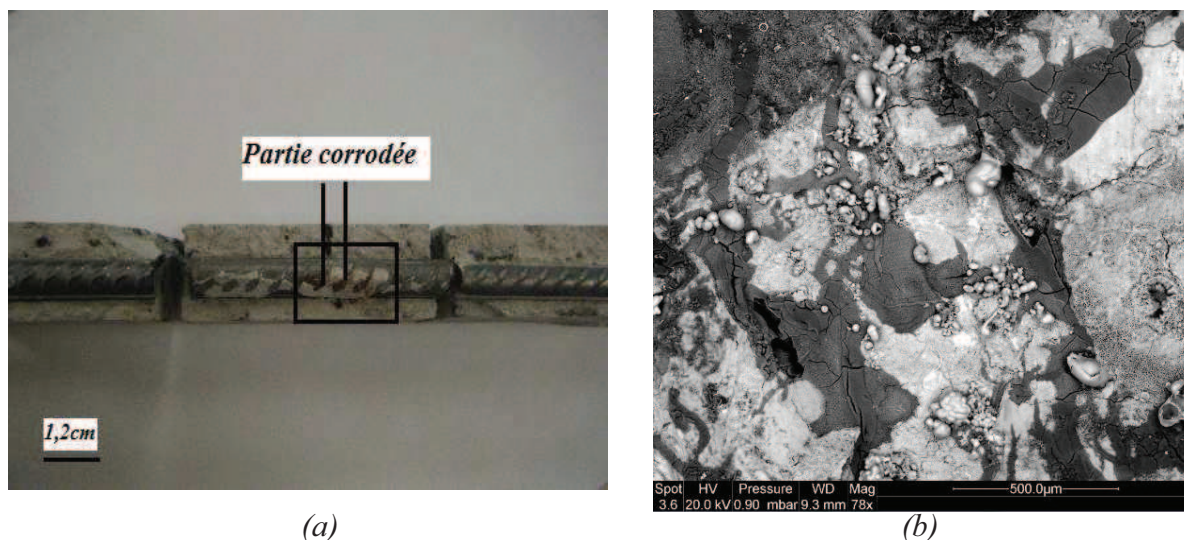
(a) : Photographie de la zone corrodée et (b) : Image au MEB de la zone corrodée, grossissement 78×
